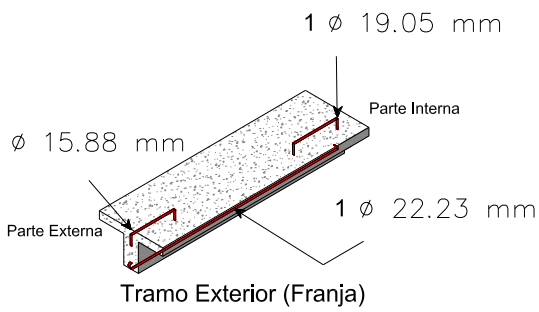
Acero de refuerzo en tramo exterior de la franja
